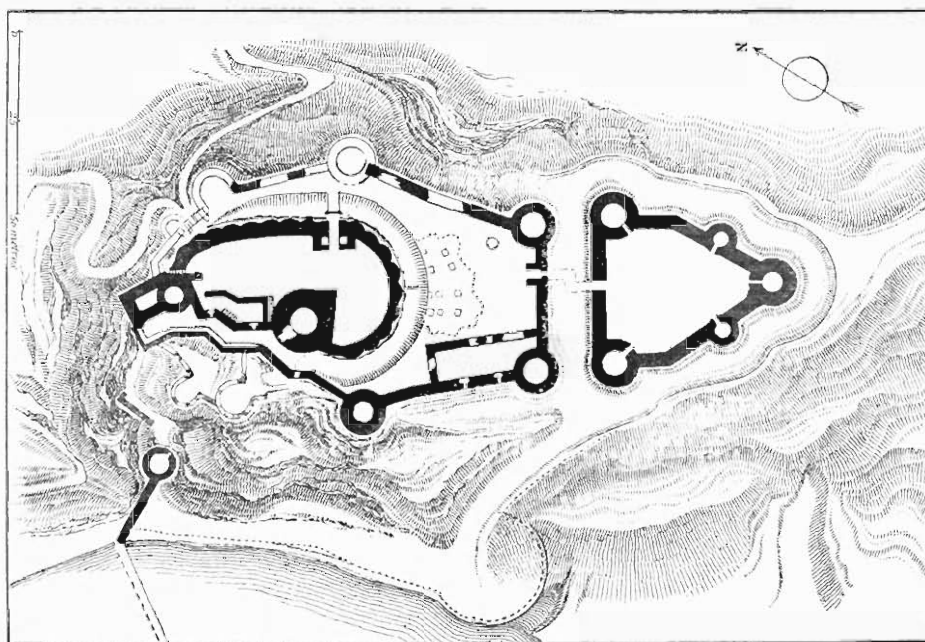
Plan du château Gaillard, d'après Viollet-le-Duc.
